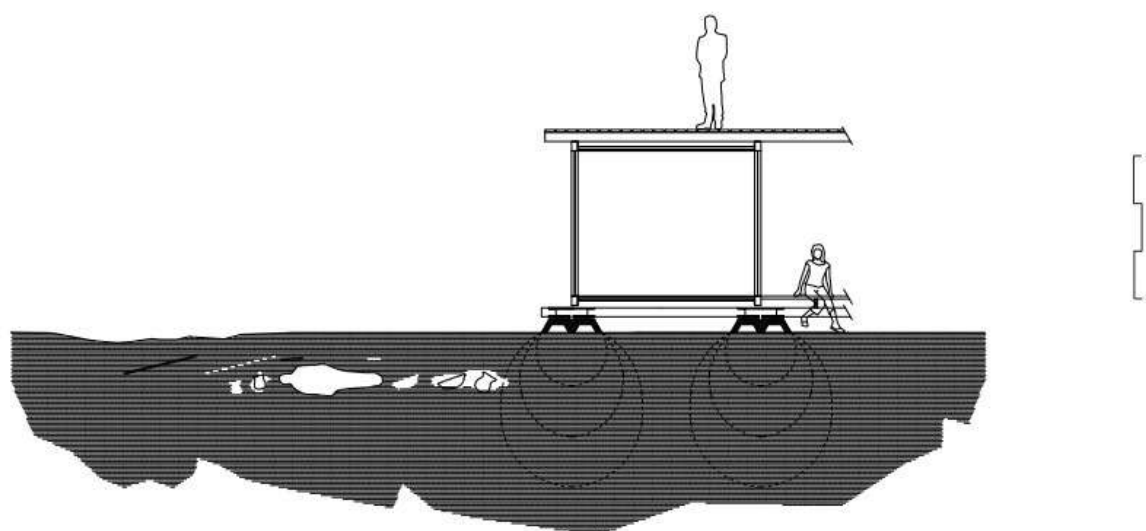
Sistema de apoyos superficiales en hormigón armado prefabricado que no requiere excavación, con un sistema de vigas principales de pino vinculadas entre sí.
